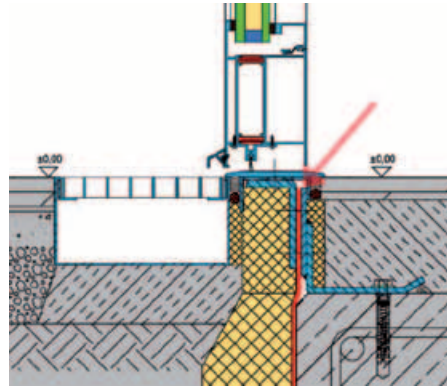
Unterer Anschluss wie unter Bild 10 beschrieben, jedoch im Türbereich mit L-förmigem Klemmprofil.
